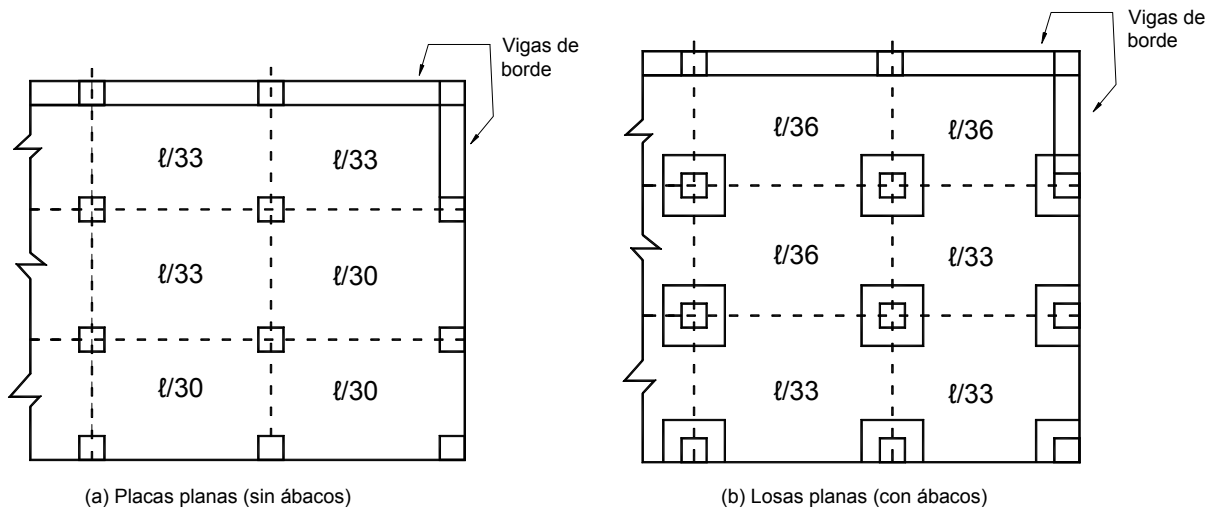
Espesor mínimo de losas sin vigas interiores entre apoyos (Armadura Grado 60)
